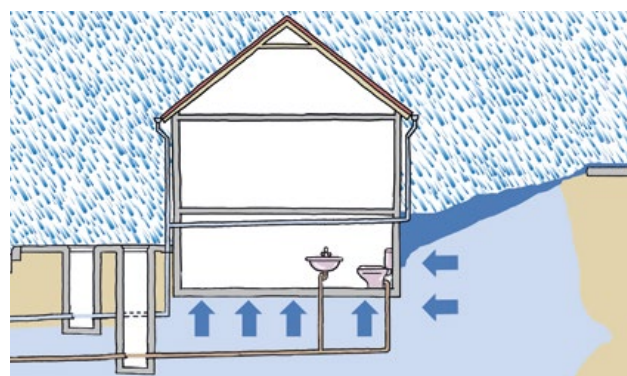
Hanglage mit „schießendem“ Wasser und Wasseraustritt aus dem Grund. Selbst ohne Rückstau aus dem Kanal kann sich Wasser am Gebäude aufstauen und eindringen.
